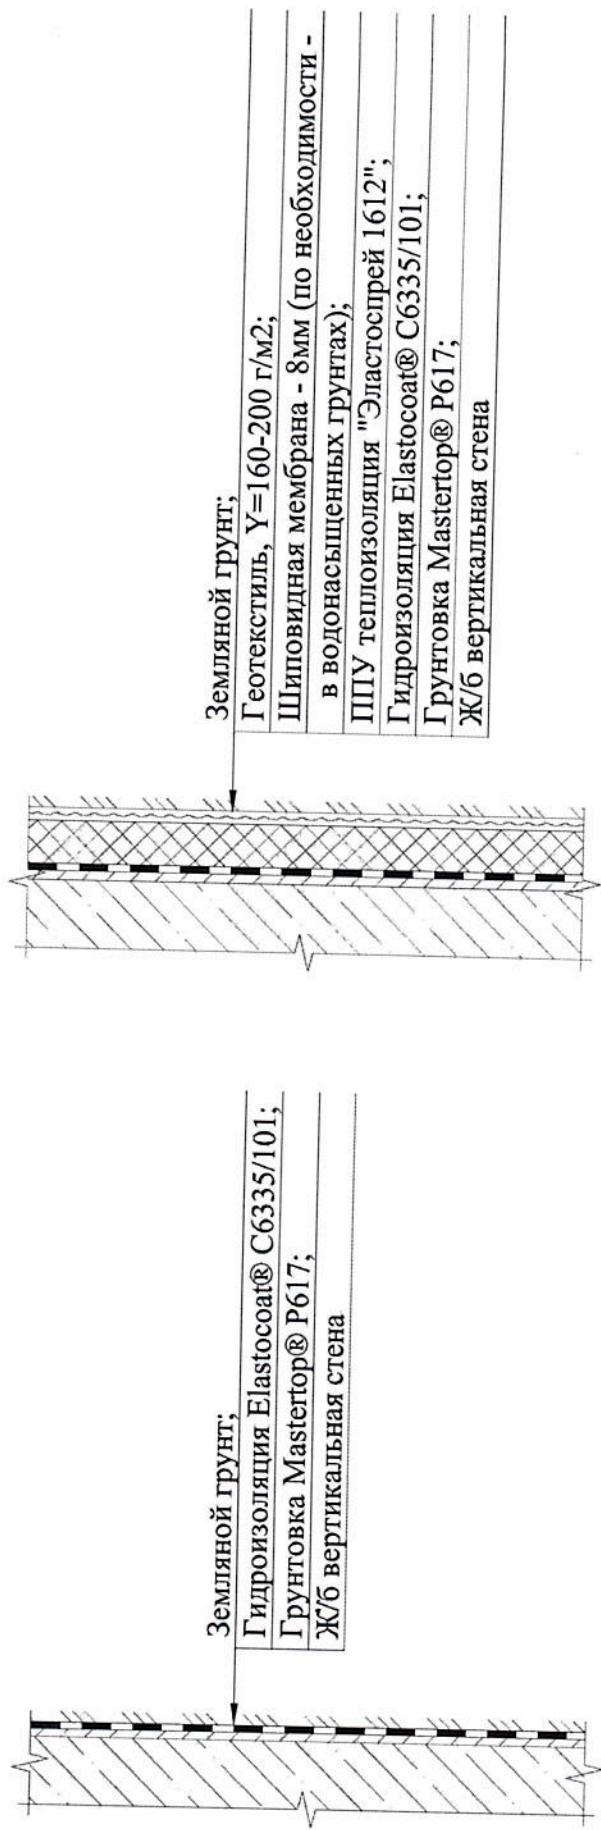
Конструктивное решение гидроизоляции стен подземных сооружений
